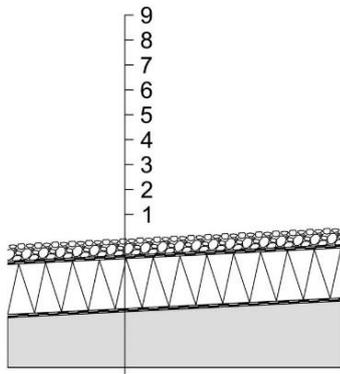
Typ III – Holzbalkenkonstruktion [3]
